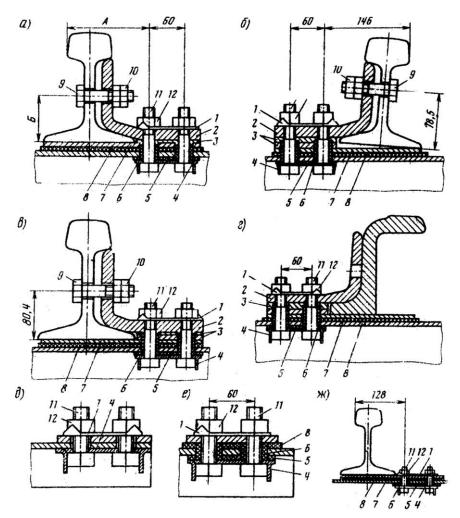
Крепление и изоляция фундаментных угольников к рельсам: а — Р43, Р50, Р65; б - Р65 с подуклонкой; в — Р75; г — к усовику крестовины с подвижным сердечником; д - гарнитуры черт. № 16348-00-00; е - гарнитуры черт. № 16379-00-00; ж - на перекрестной стрелке; 1, 4 — планки стопорные; 2, — угольник к стрелкам; 3, 7 — подкладки; 5, 8 — прокладки изолирующие; 6 — втулка для изоляции; 9, 11 — болты; 10, 12 — гайки
